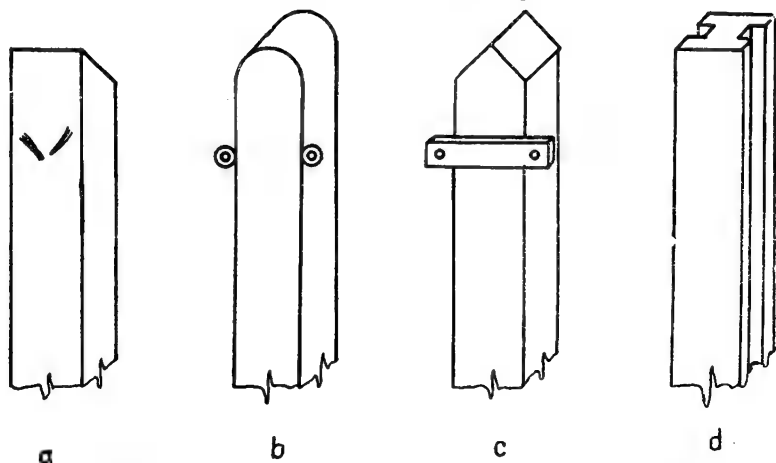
Fixarea sîrmei ghimpate sau a împletiturii de sîrmă pe stâlpi prefabricați de beton armat ai împrejmuirilor :
